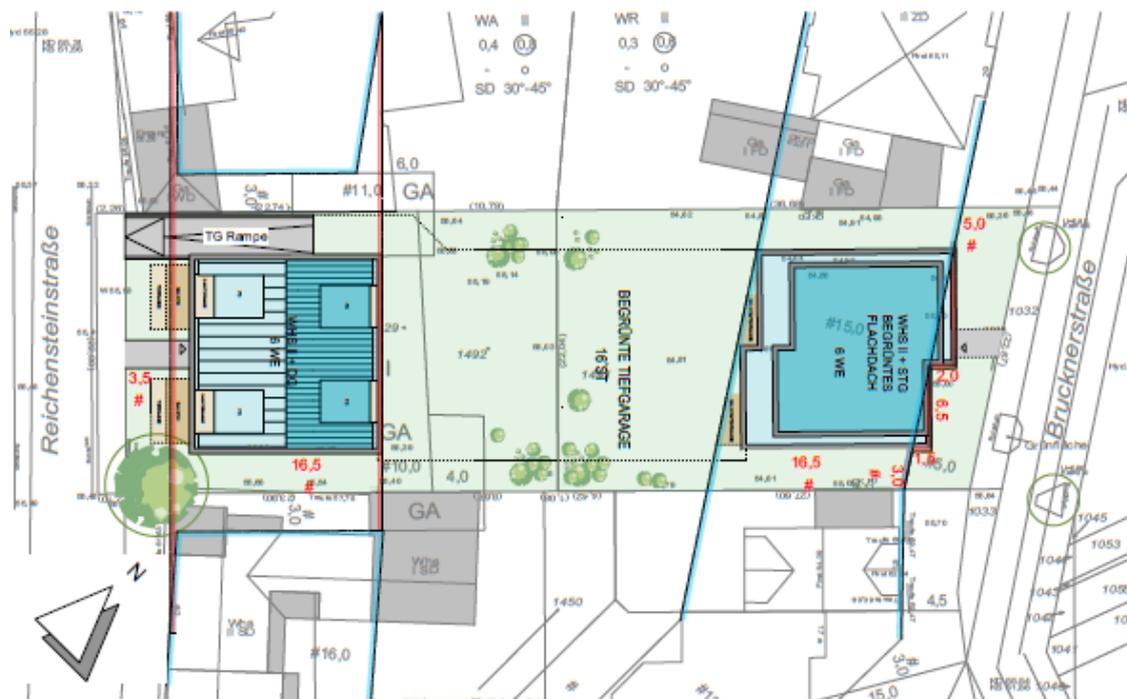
Entwurf überbaubare Flächen mit geplanten Wohngebäuden und Tiefgarage im Änderungsbereich
